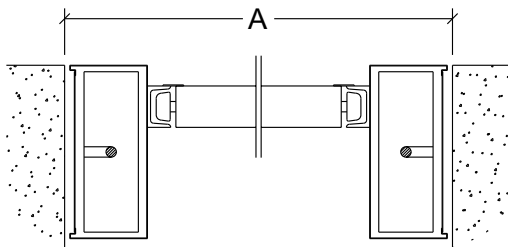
Detalle en planta de puerta industrial basculante con cajoneras.
